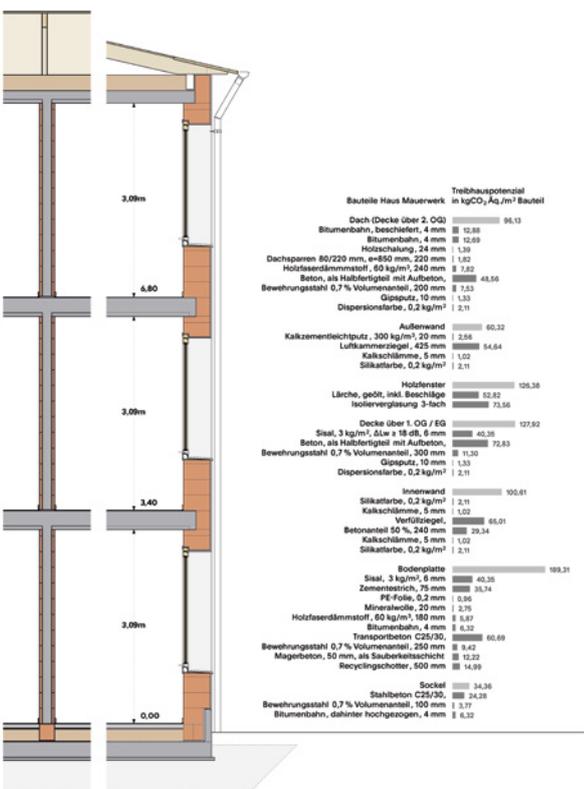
Haus Mauerwerk: Detailschnitt und Treibhauspotential der Bauteile
